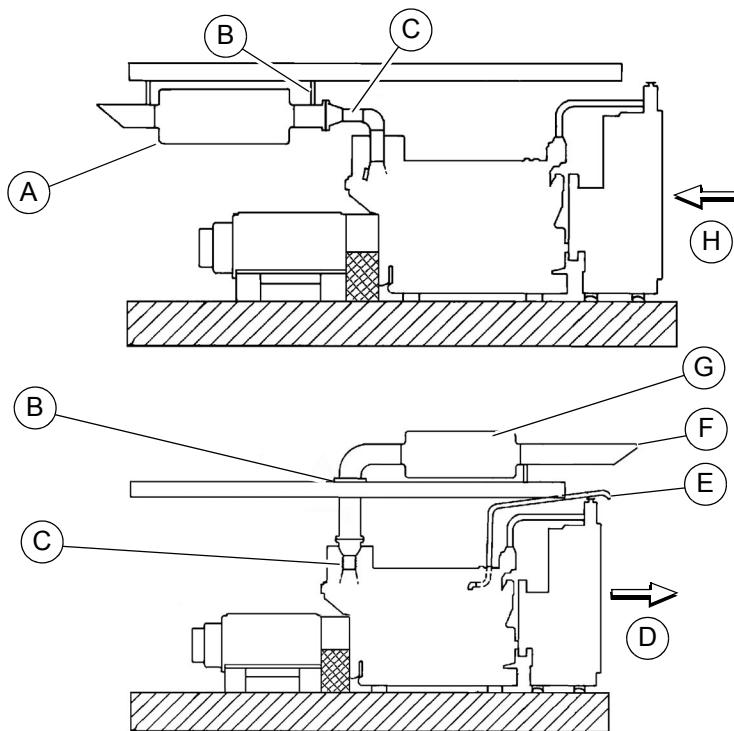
Типовой вертикальный (сверху) и горизонтальный (снизу) глушитель
